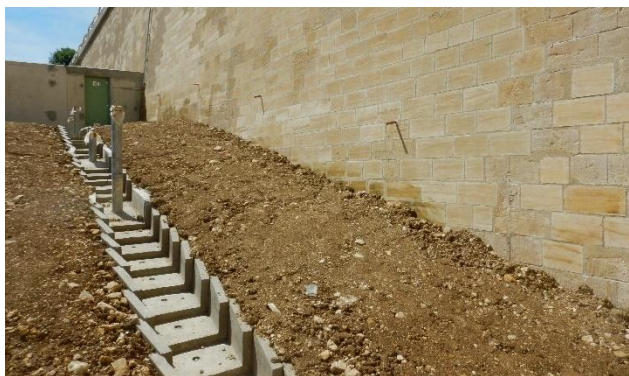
Exemple de caniveau en béton – Barrage du Bairon – Safège
